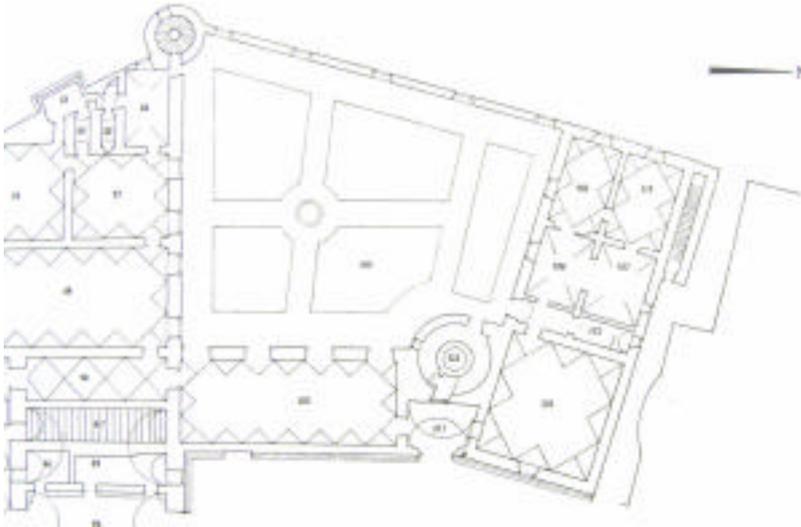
Grundriss des ersten Obergeschosses mit dem giardino pensile (Rotondi 1969, Abb. 49)
